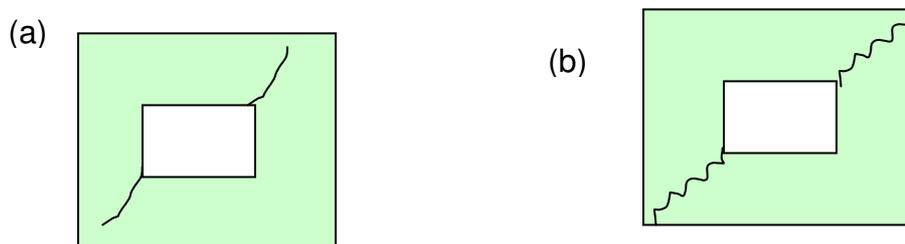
Tipos de fissuras em alvenarias devido a movimentações diferenciais das fundações (SILVA, 1993).
